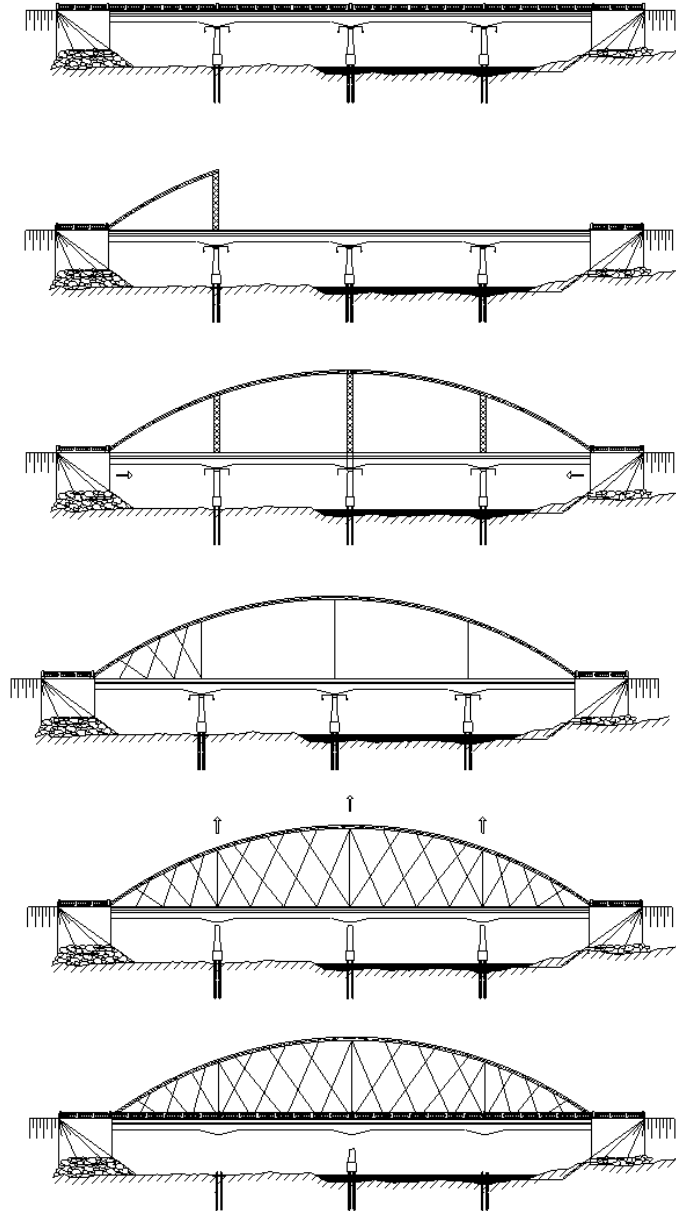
7. Esquema de las etapas constructivas propuestas para obras de refuerzo.
